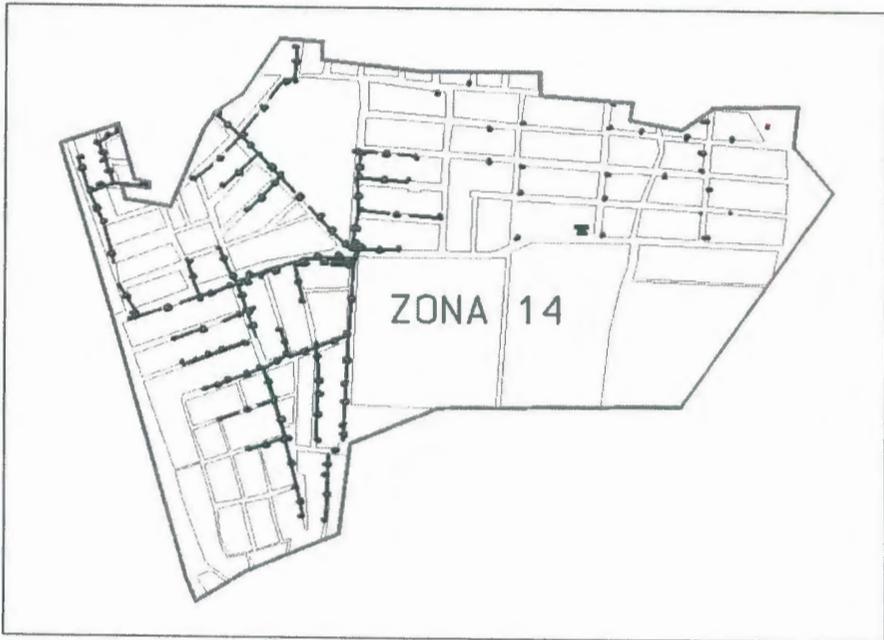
Planimetría zona 14 del sector de la vía a Daule
